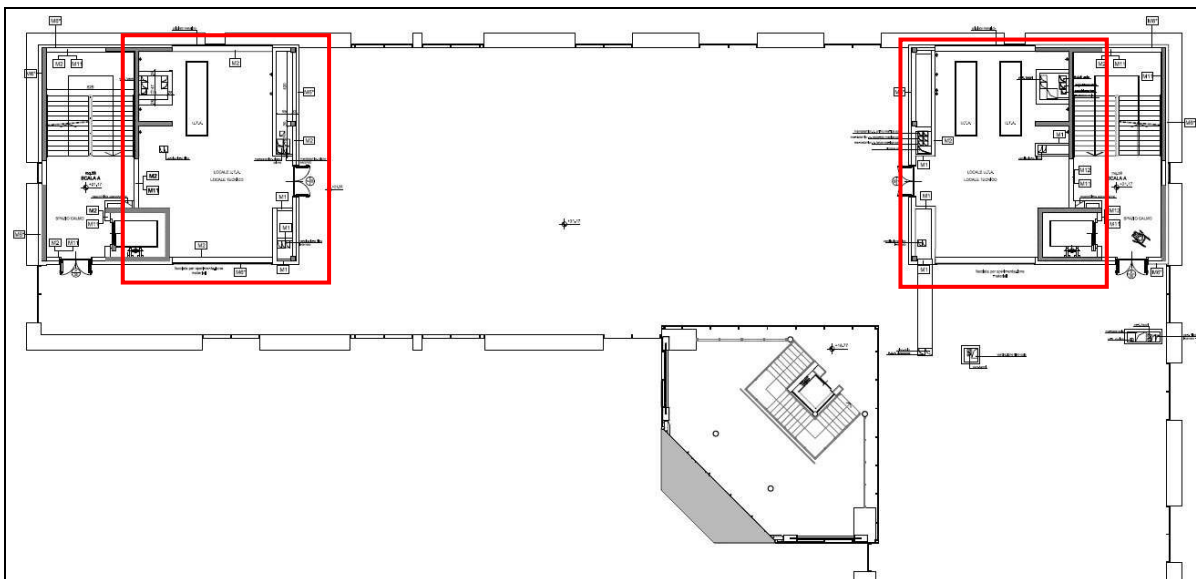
Stralcio della pianta del piano terrazzo con indicazione dei locali UTA.
